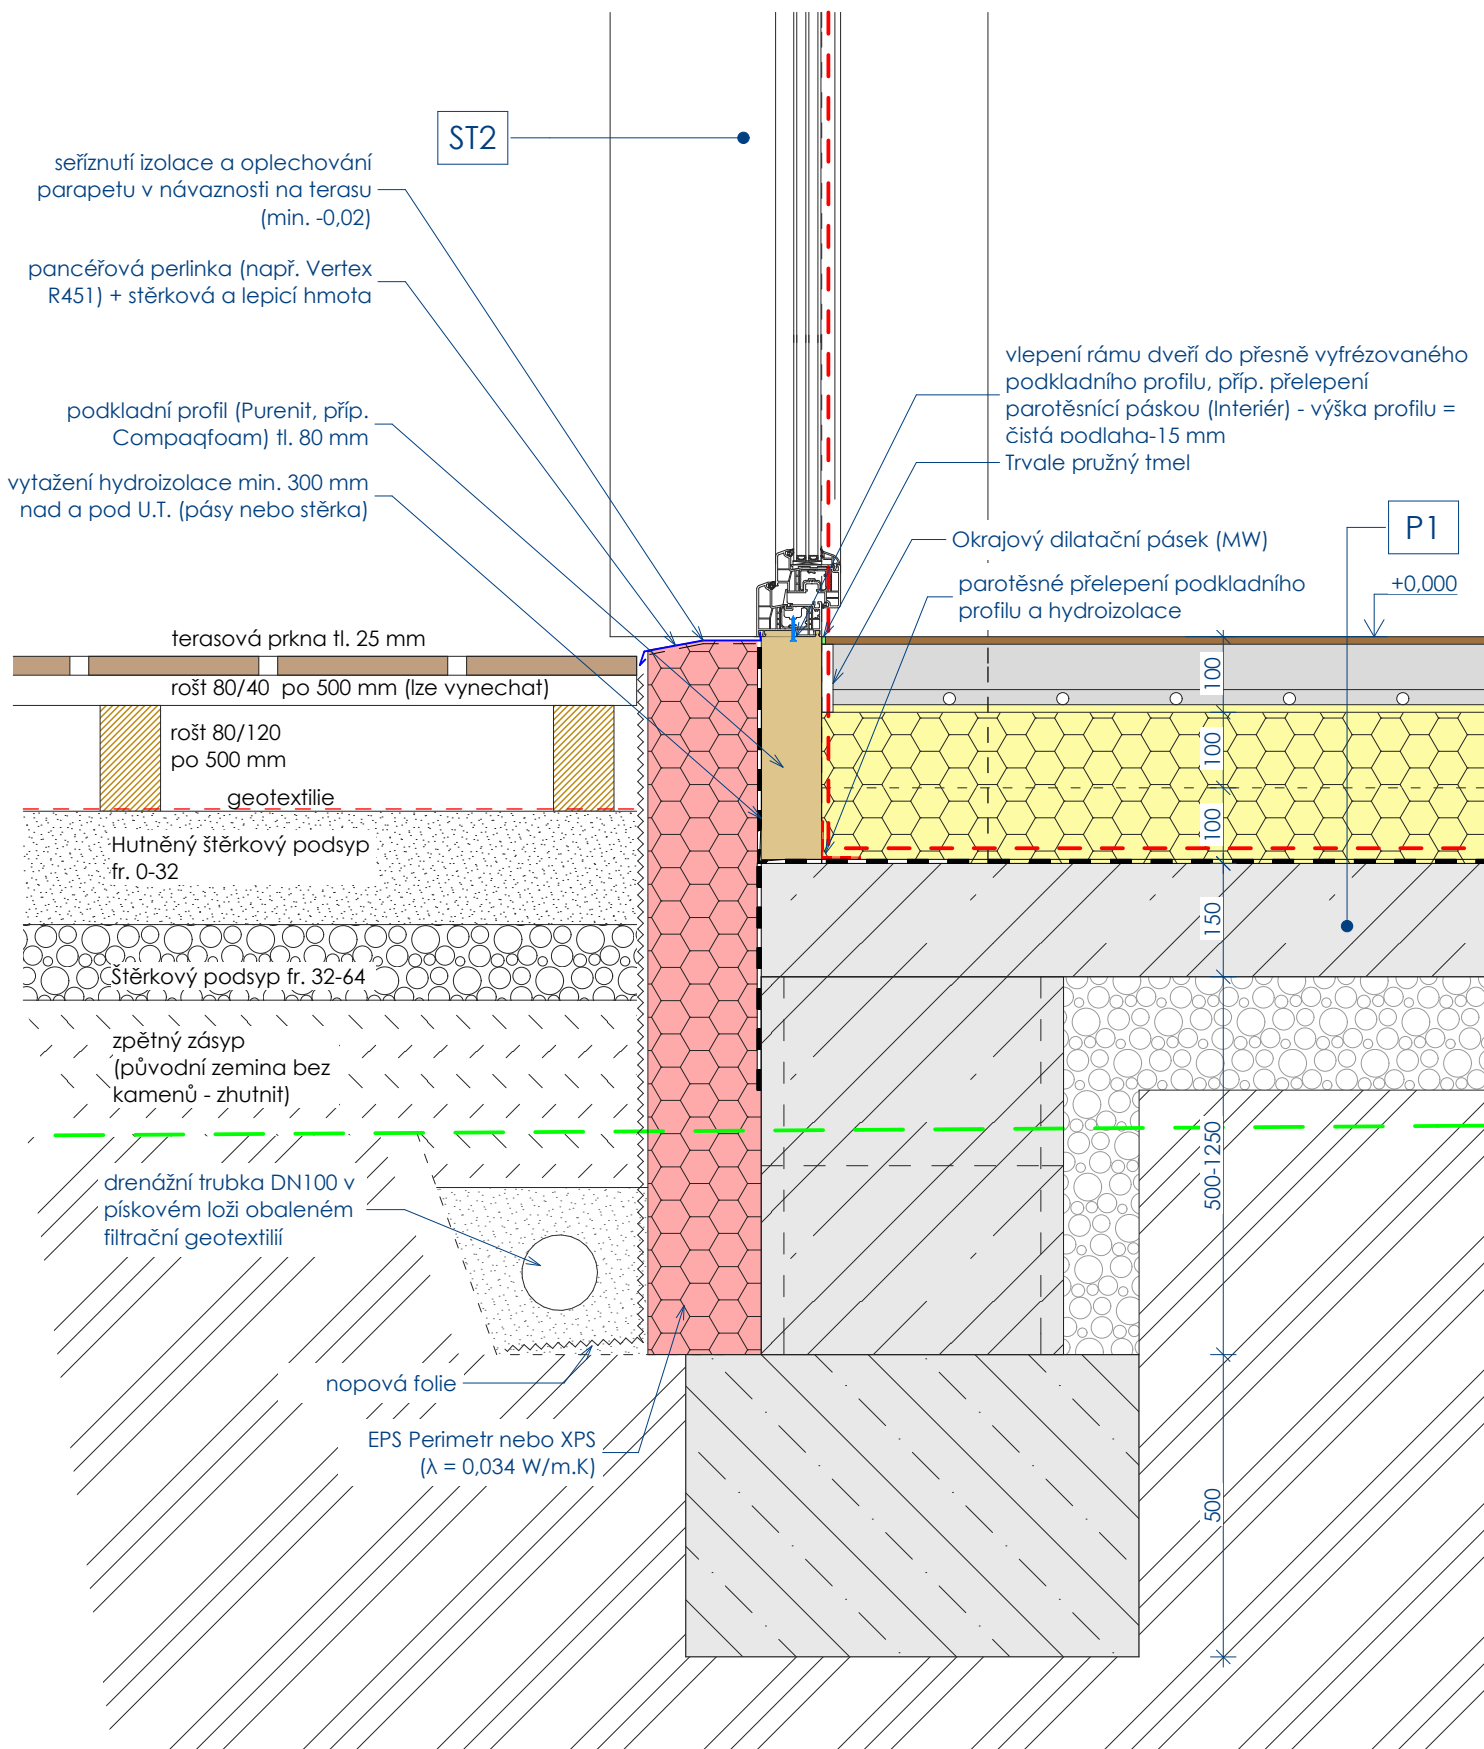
NÁROŽÍ - NAPOJENÍ
